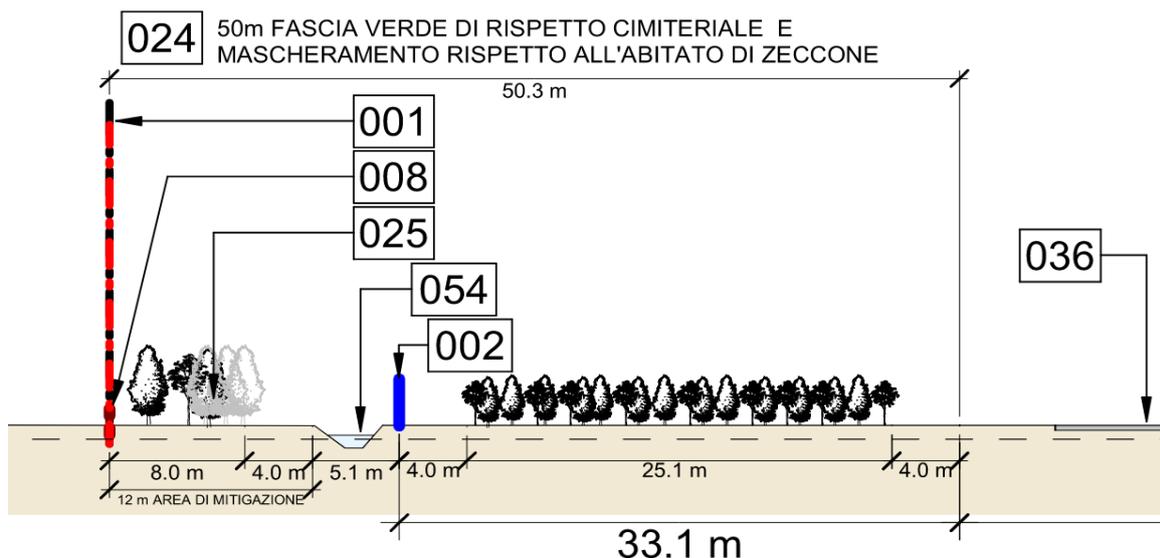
Sezione lungo la fascia verde di rispetto cimiteriale e mascheramento rispetto all'ambito di Zeccone
